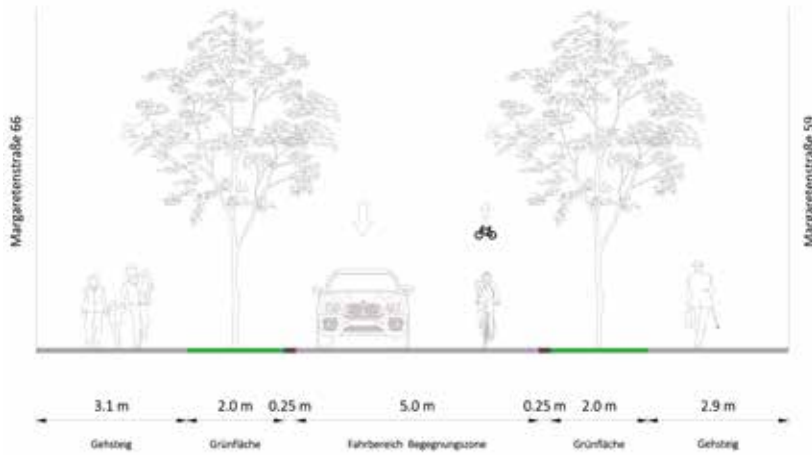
Querschnitt 1: Margaretenstraße 66, Richtung Nordosten
